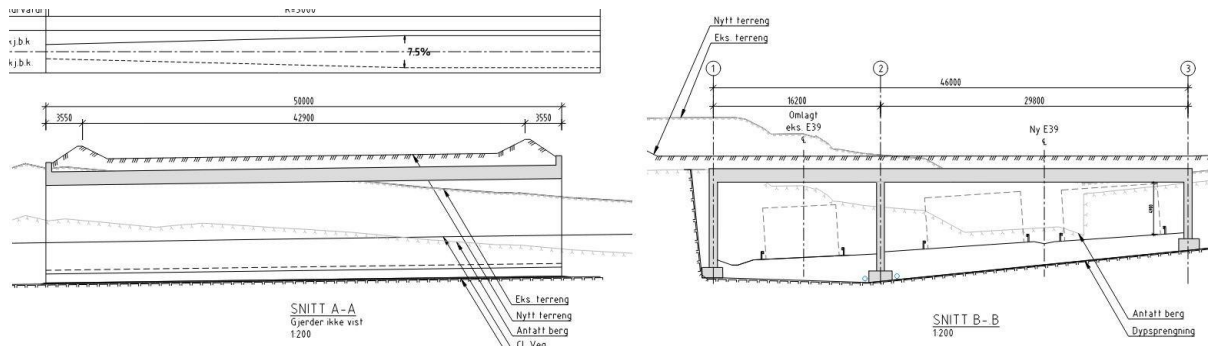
Flaten kulvert – fra konstruksjonsrapport (Sweco Norge AS, 2021)
